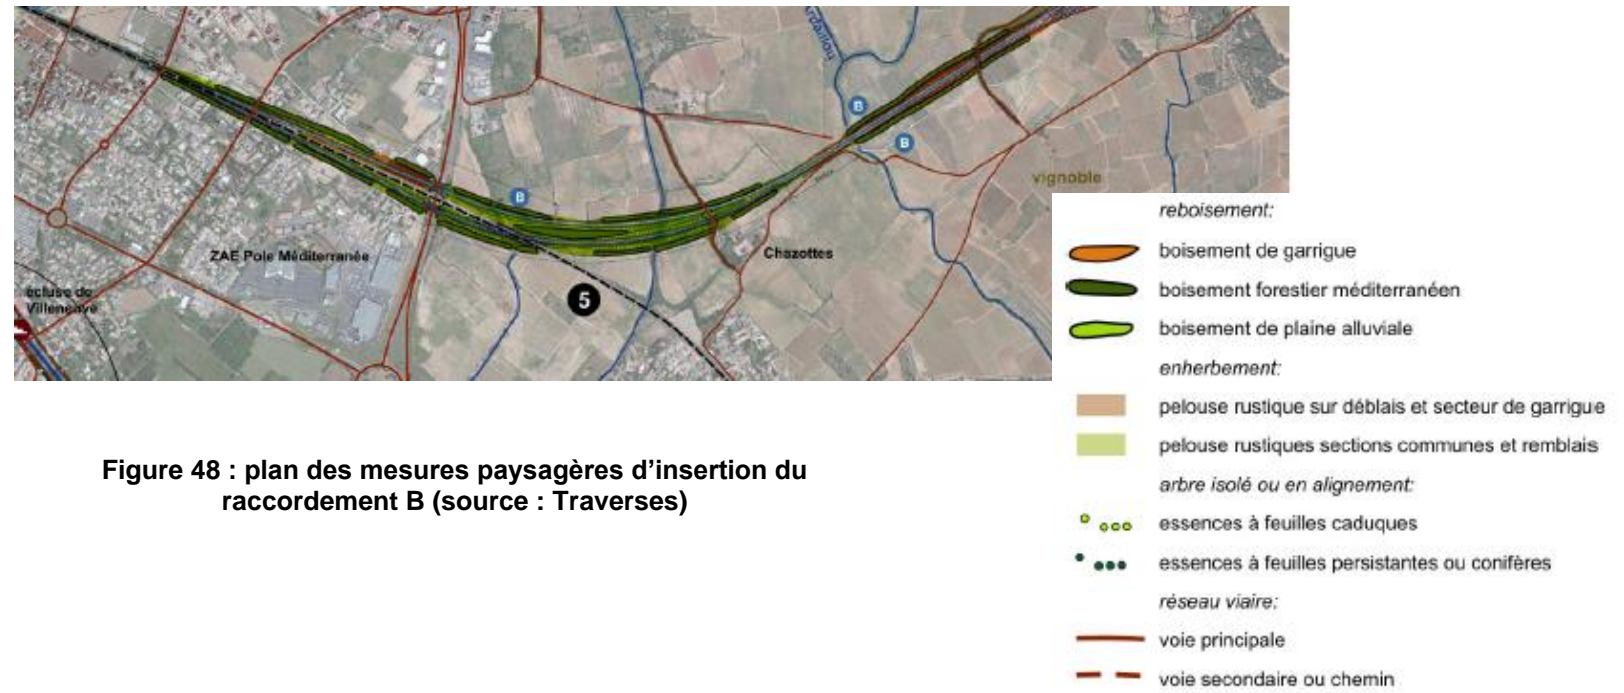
plan des mesures paysagères d'insertion du raccordement B (source : Traverses)
